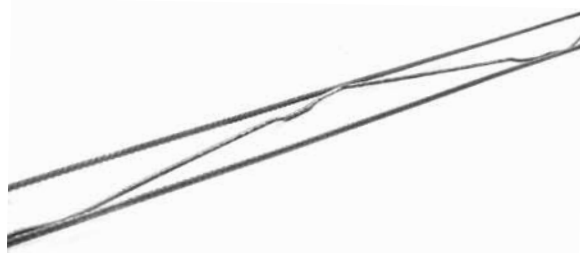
Армирование для кладки стен на традиционном растворе MURFOR®+
